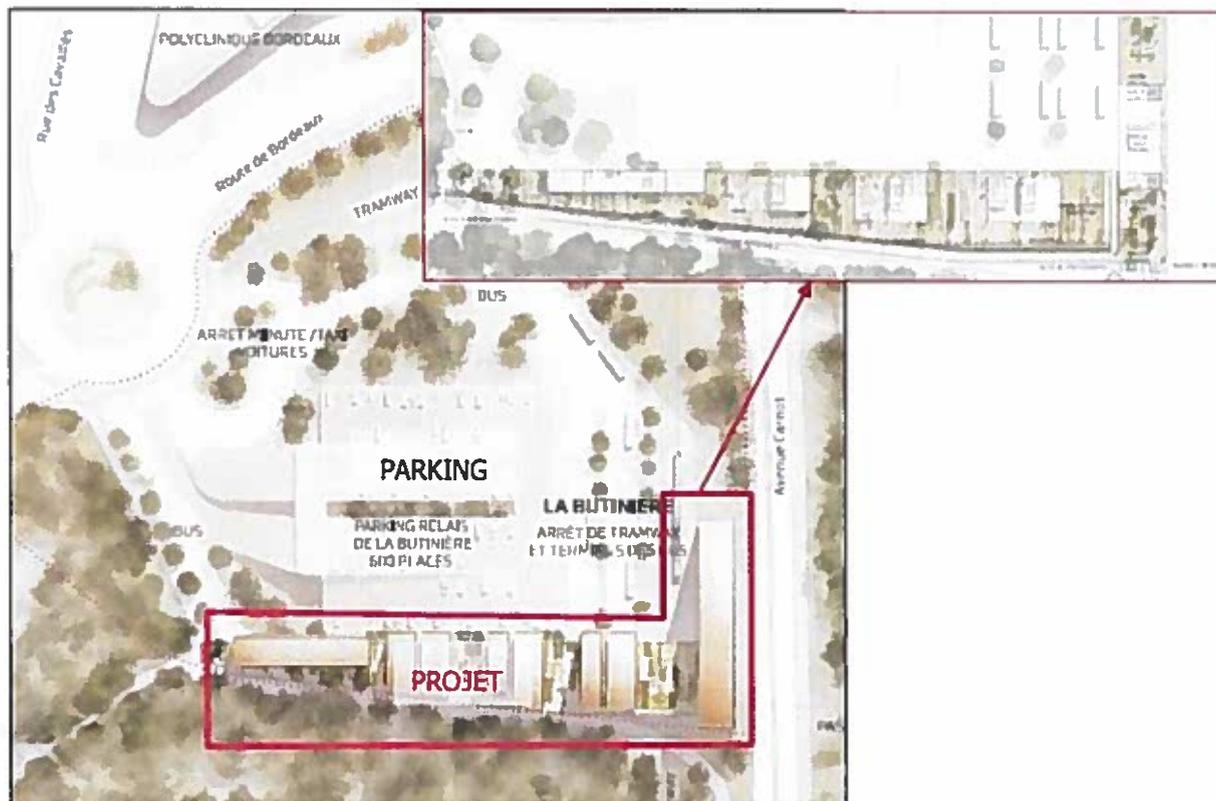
Plan a plat – Source rapport BURGEAP RACISO01714-02/ CACISO141751
